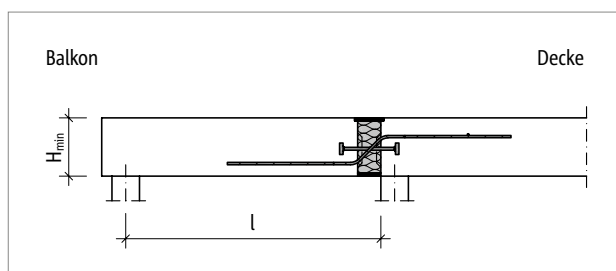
Schöck Isokorb® T Typ QP: Statisches System
